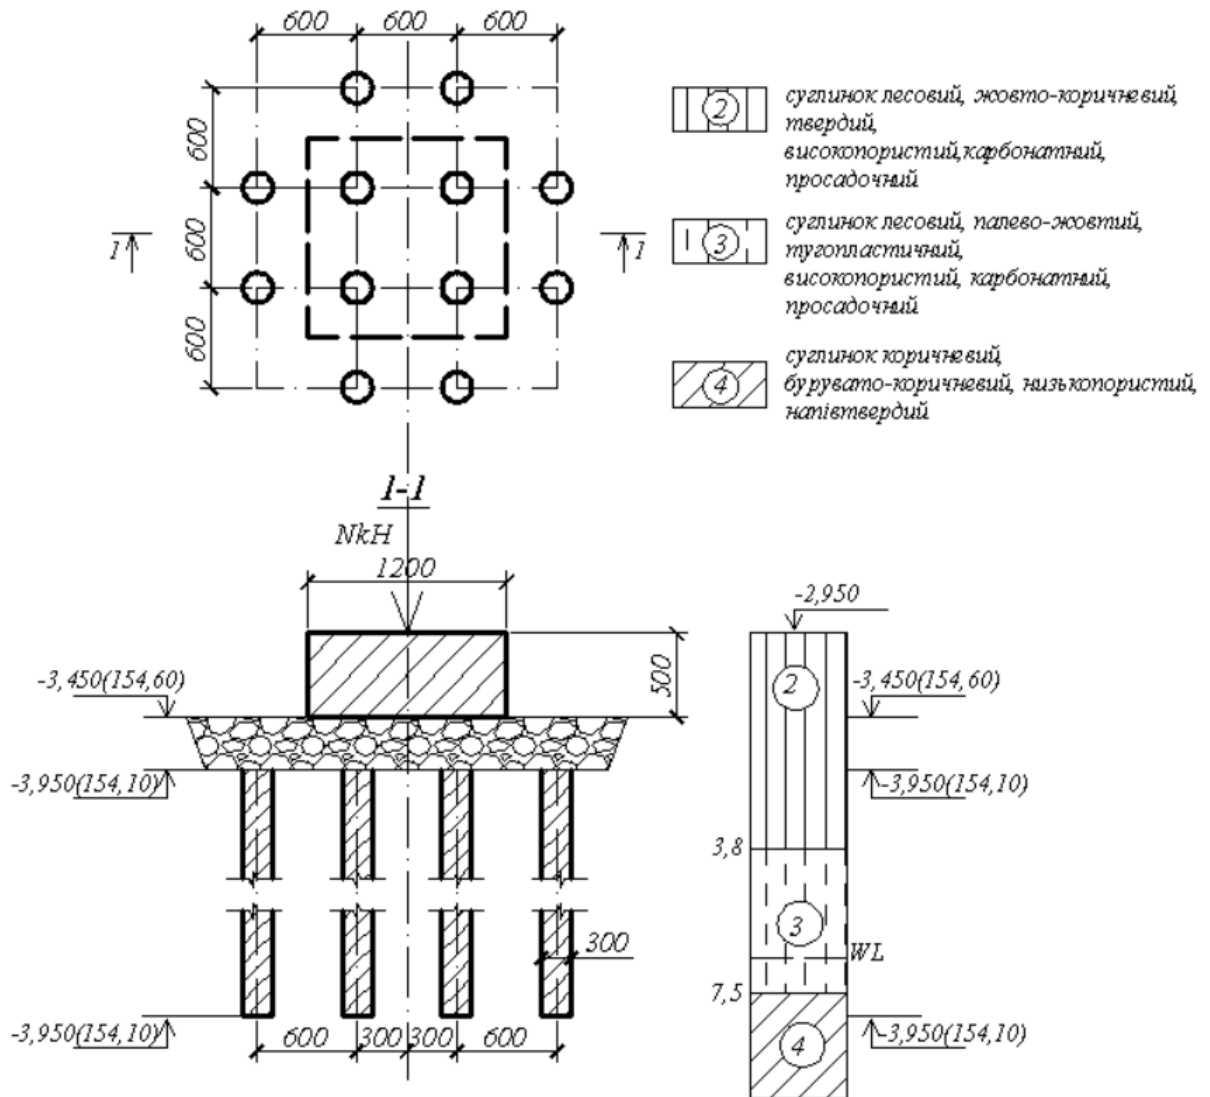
Схема випробувань армованої основи залізобетонним квадратним штампом
